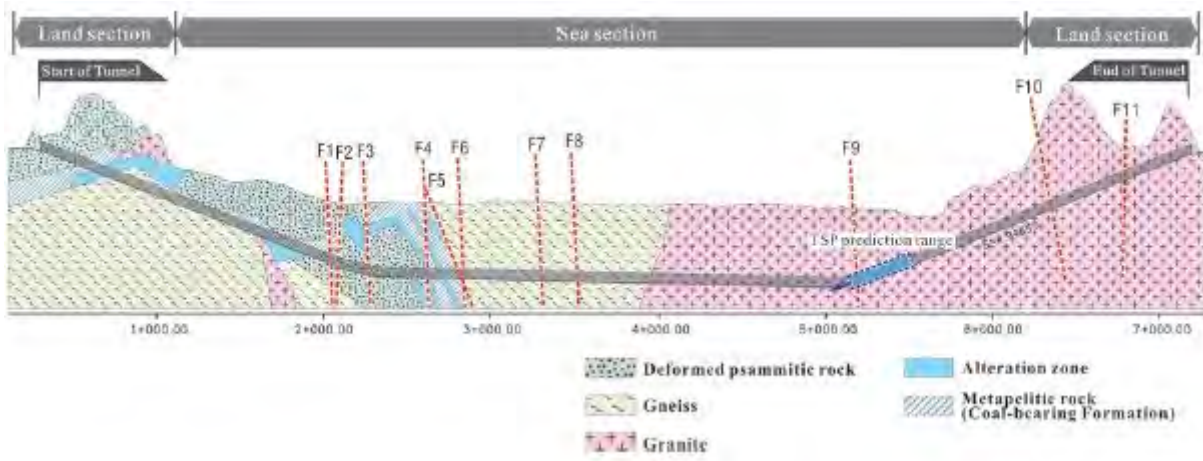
Boryeong Tunnel – Sezione longitudinale
